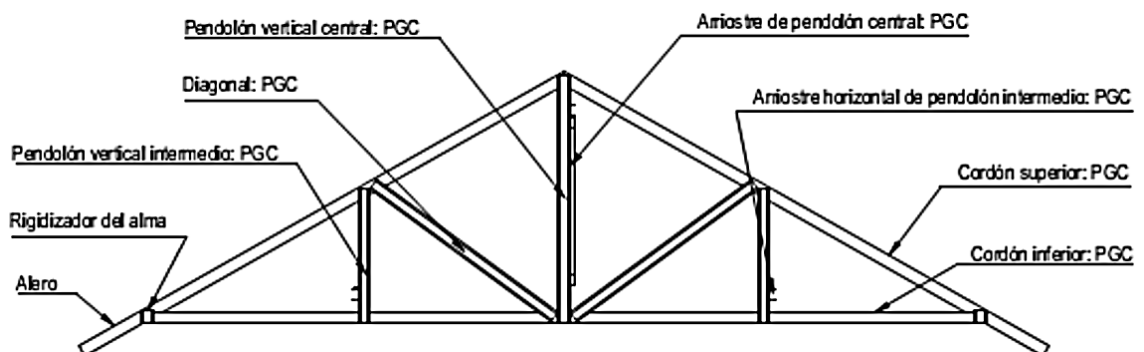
Detalle cubierta inclinada, Steel Frame
